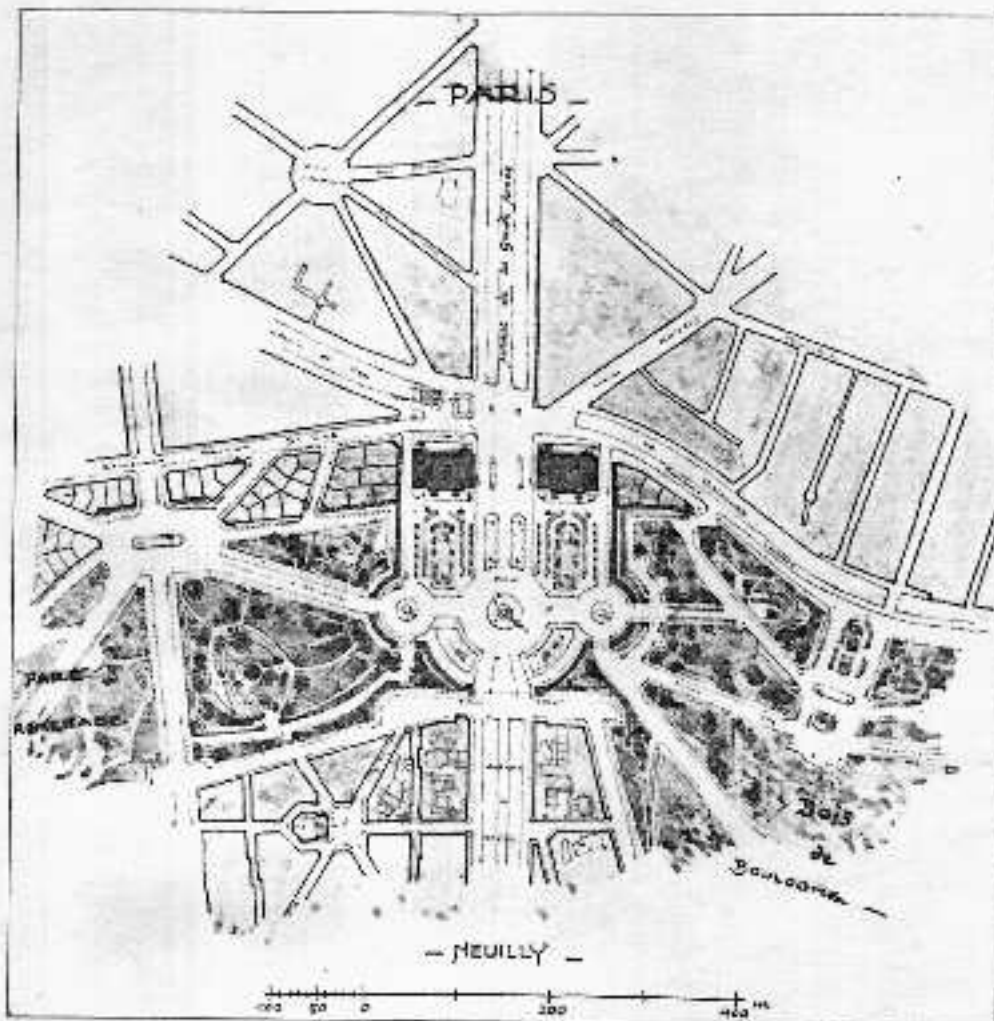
Entwurf zur Bebauung und Umgestaltung der Pariser Umwallung, einschließlich der militärischen Zone, an der Porte Maillot.
